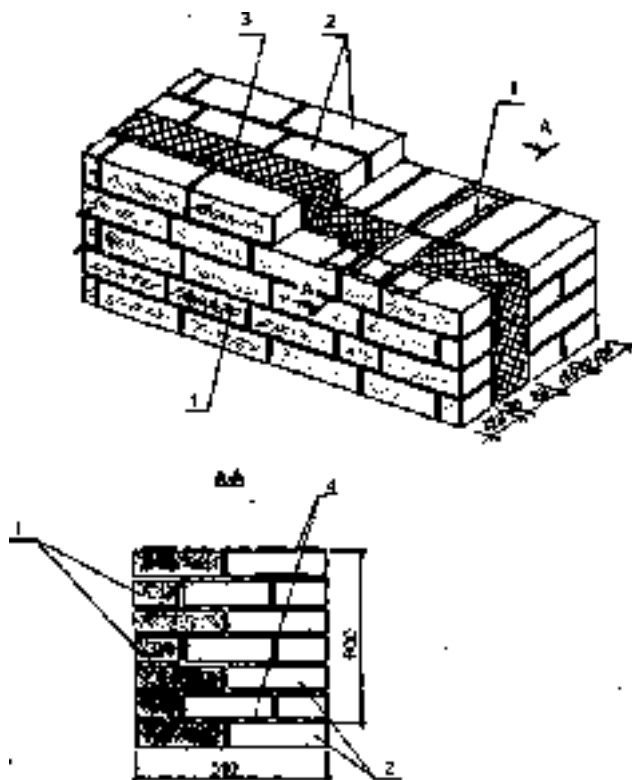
Кирпичная кладка наружных стен с жесткими связями и утеплением пенополистирольными плитами:
